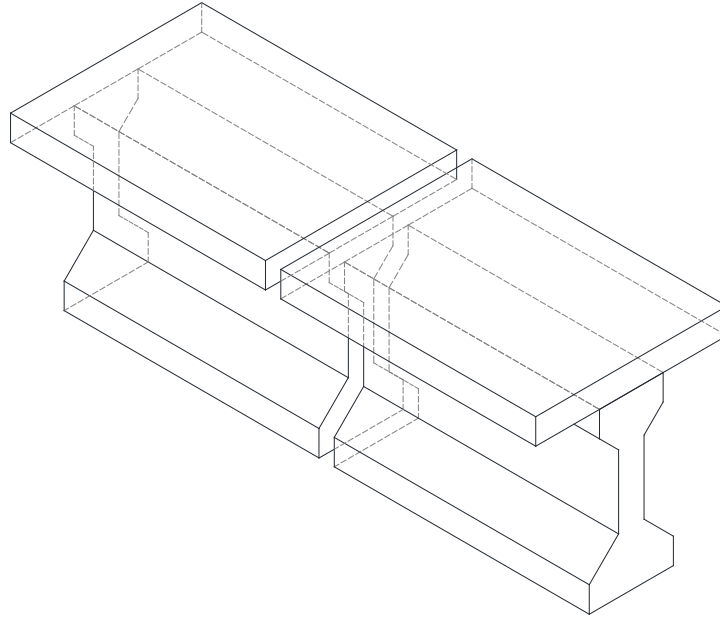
Detalle en que se muestra un segmento de la superestructura del puente, en el cual se observa la junta de dilatación entre las traveses y en la losa de cubierta. Modelo 1
